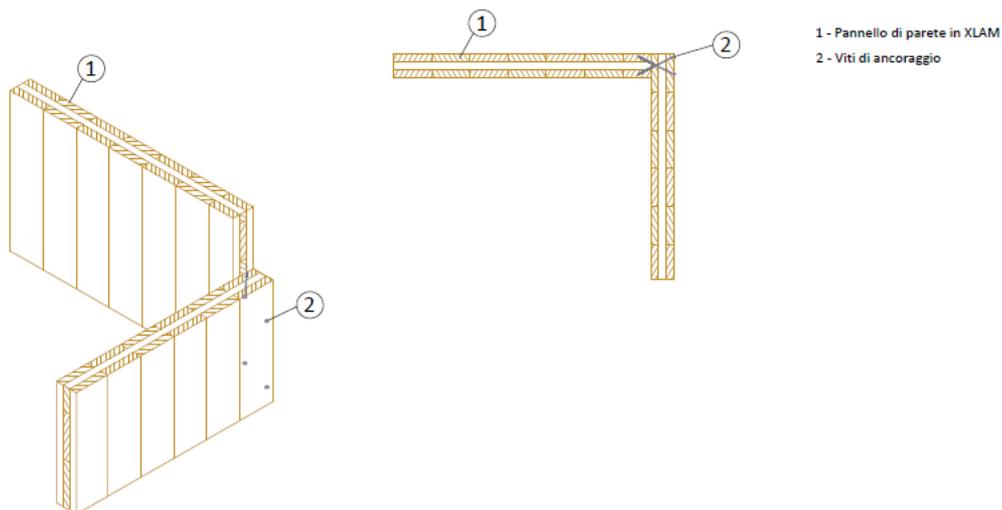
Collegamento parete-parete d'angolo tramite viti di ancoraggio
